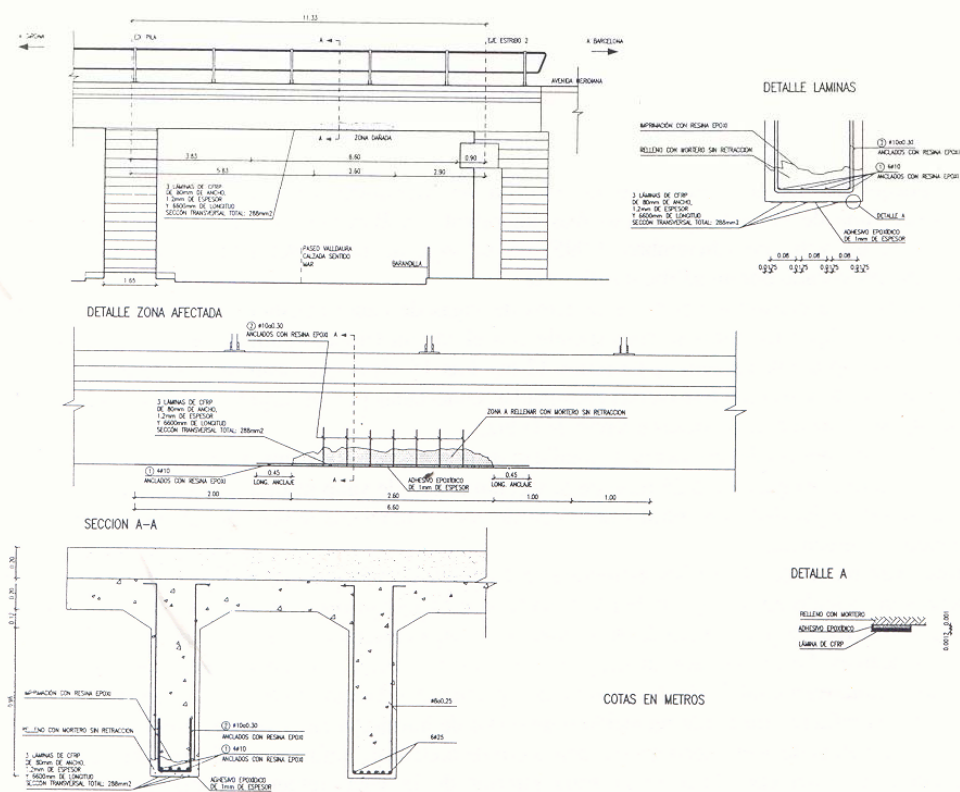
Reparación Puente del Dragó. Alzado y secciones.
